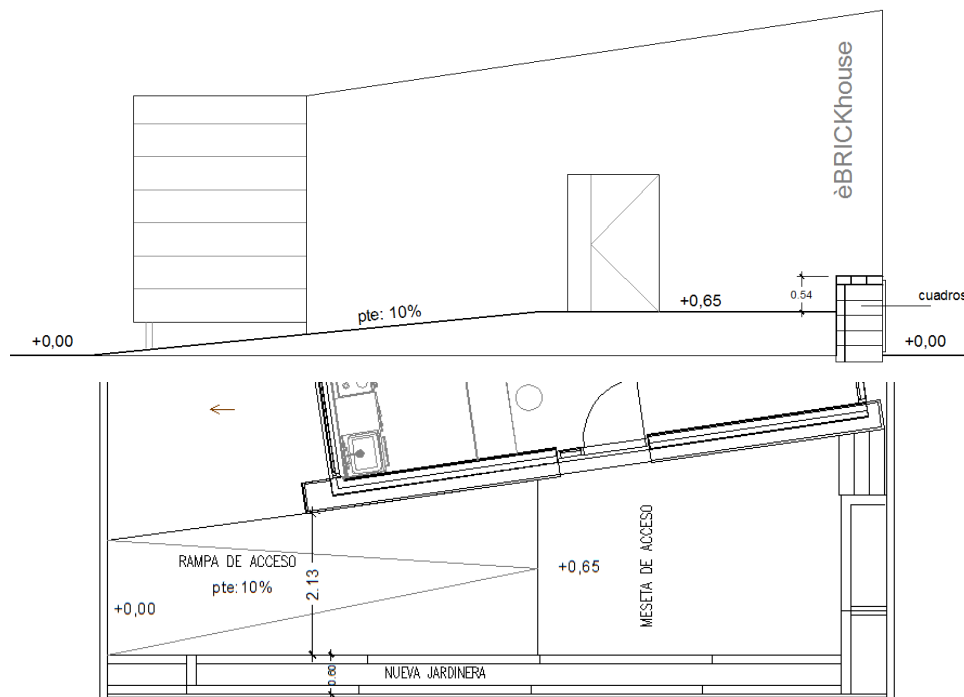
Diseño en planta y sección de la rampa / [EP]
